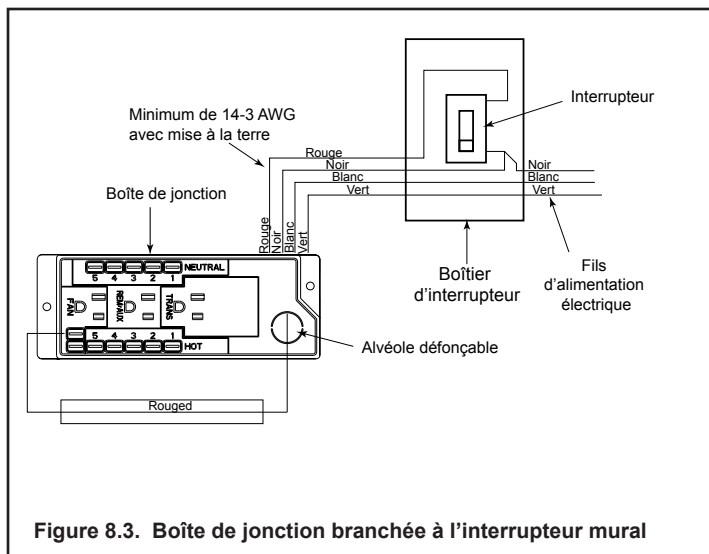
Boîte de jonction branchée à l'interrupteur mural
